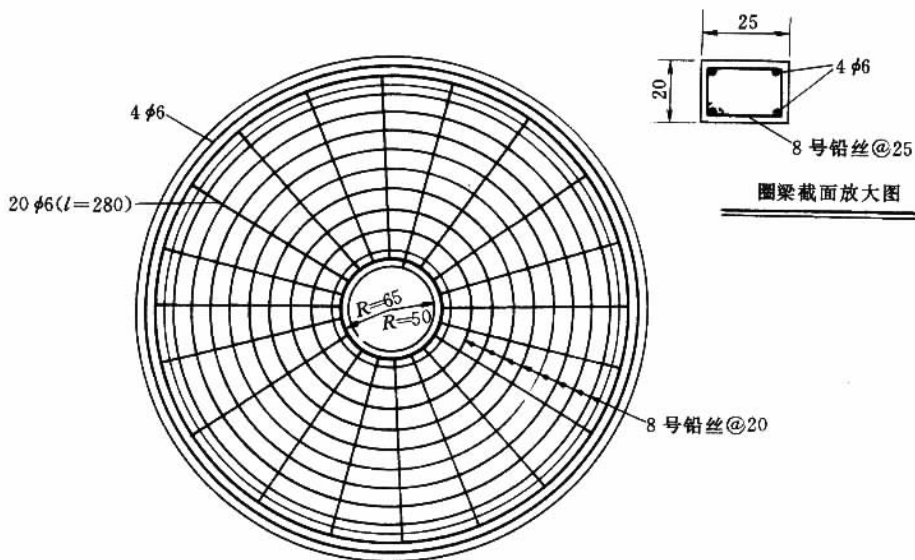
混凝土帽盖窖铅丝网平面图 (单位: cm)
